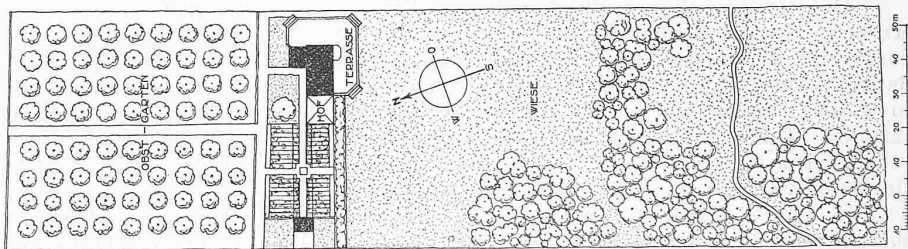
Haus Plesch bei Hamburg. Arch. H. Muthesius. — Lageplan 1:2000 (Grundrisse auf S. 197).
